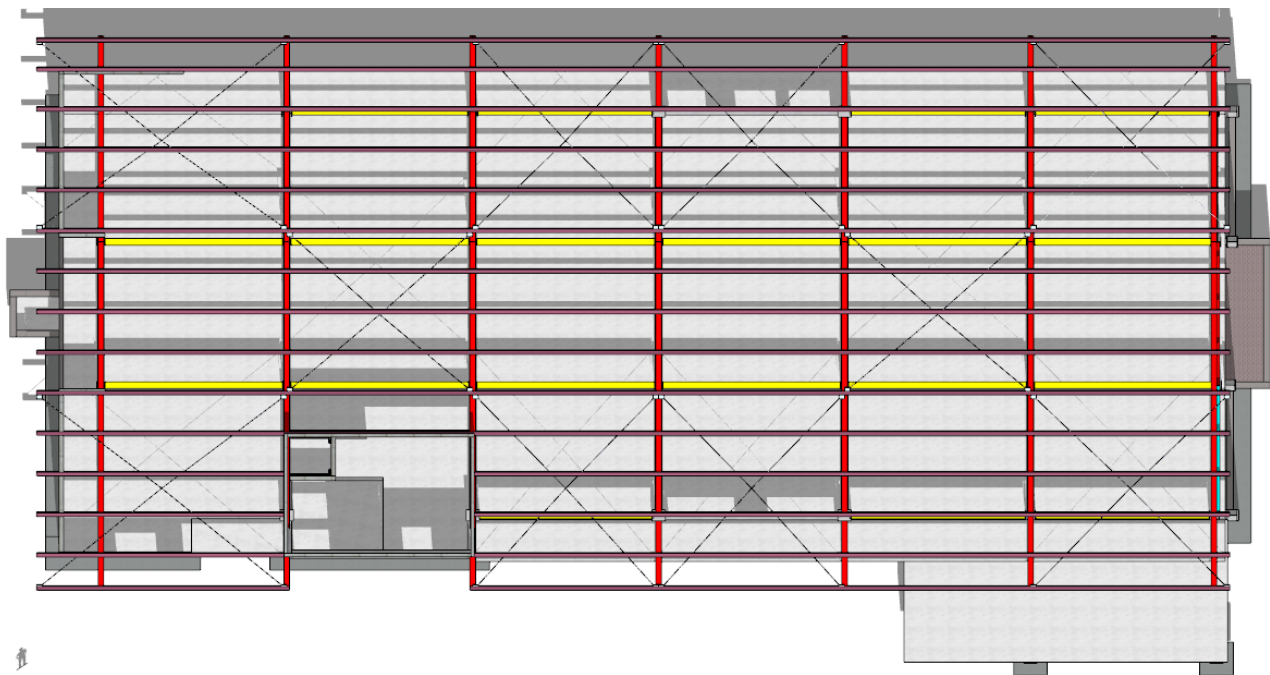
Planta esquemática de distribución estructural de techos. Fuente: Elaboración propia
